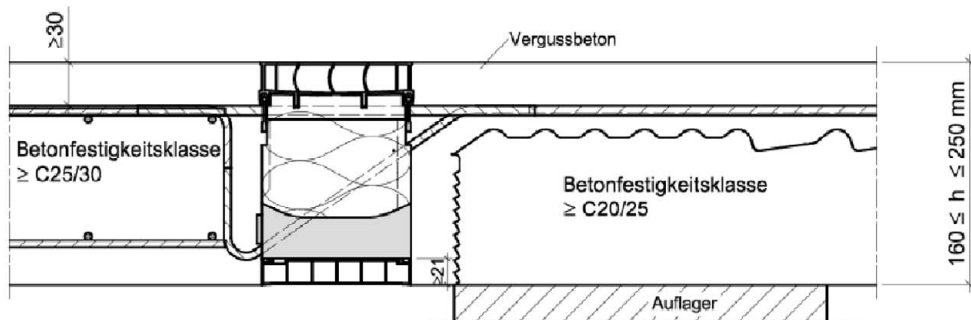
Beispiel Schöck Isokorb® XT Typ K-ID mit Betondrucklager in eingebautem Zustand mit Vergussfuge
